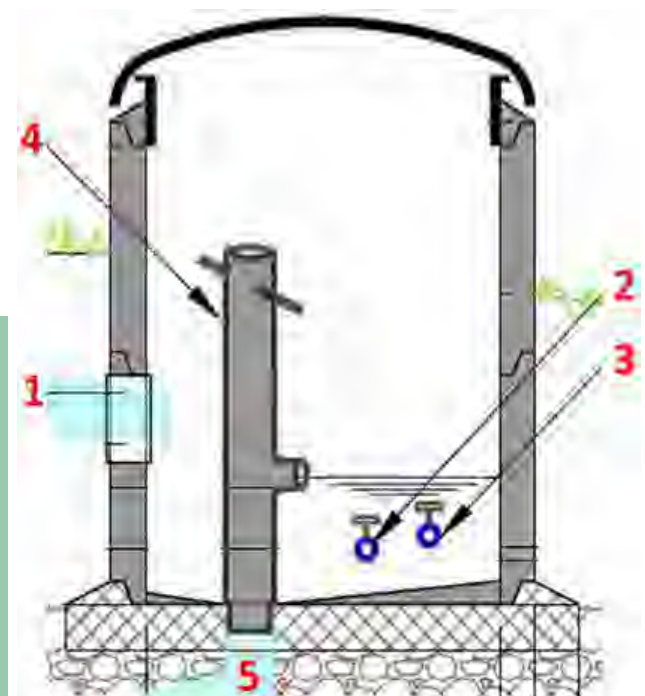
Schema des Fassungsschachts: 1. Quelfassung / Zuleitung, 2. Mindestwasserführung min. 25%, 3. Nutzleitung Trinkwasser, 4. Überlauf mit Entleerungsstutzen, 5. Entleerung/Überlauf (Illustration: pbplan ag).
